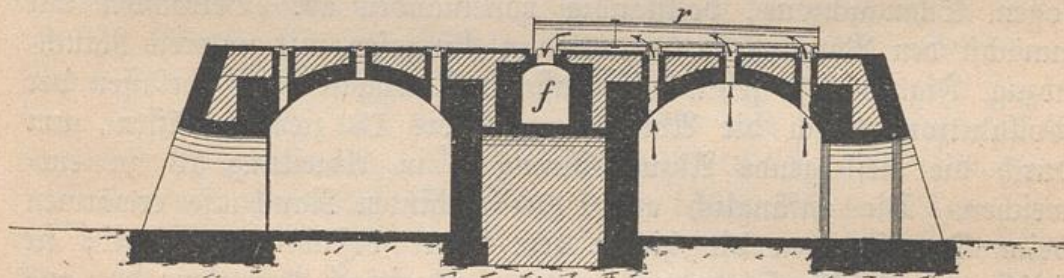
Ringofen mit oberem Rauchabzug. Querschnitt.
